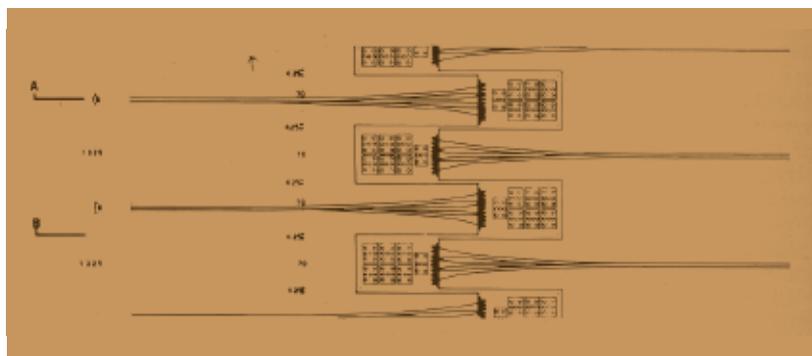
La disposizione "a pettine" delle travi in c.a.p.
